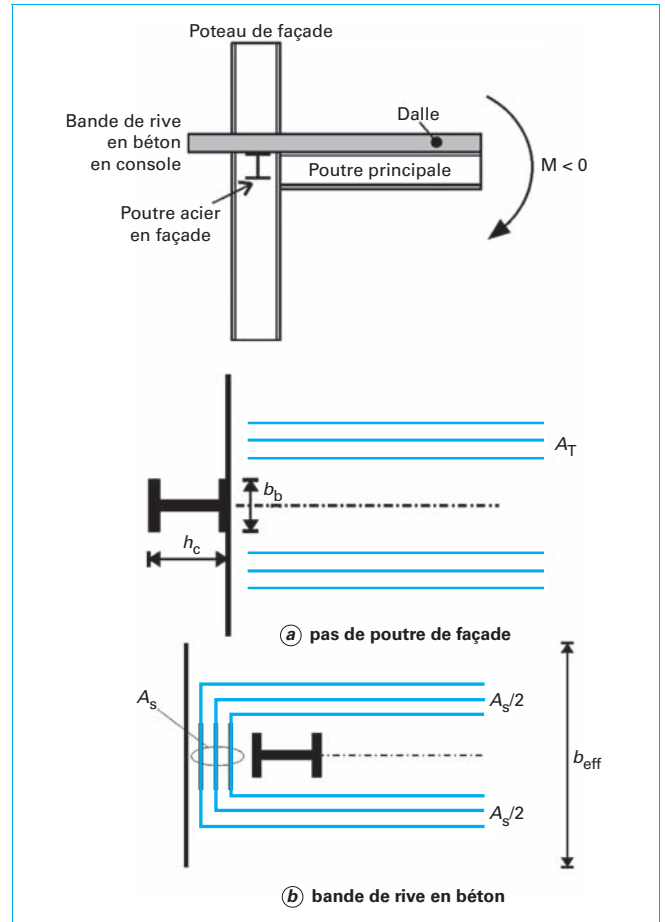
Transfert d'un moment négatif M à un poteau de façade
